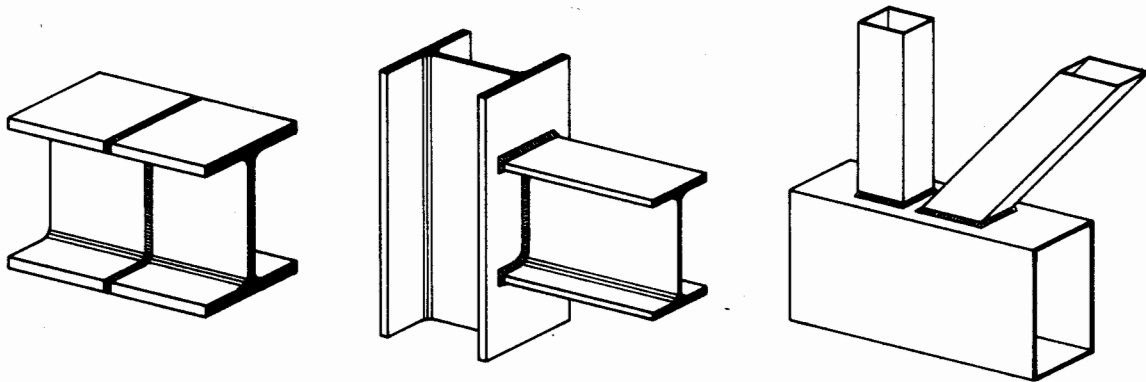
Exemples d'assemblages soudés.
